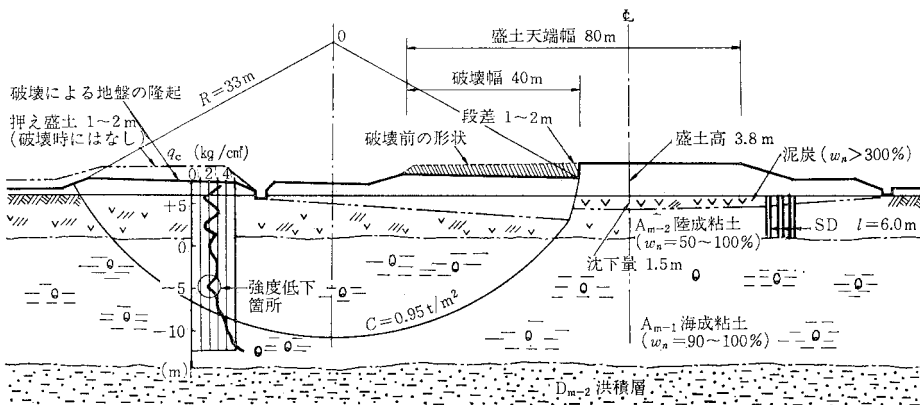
岩槻地区すべり破壊箇所横断面図 (Hランプ STA 1+00)
